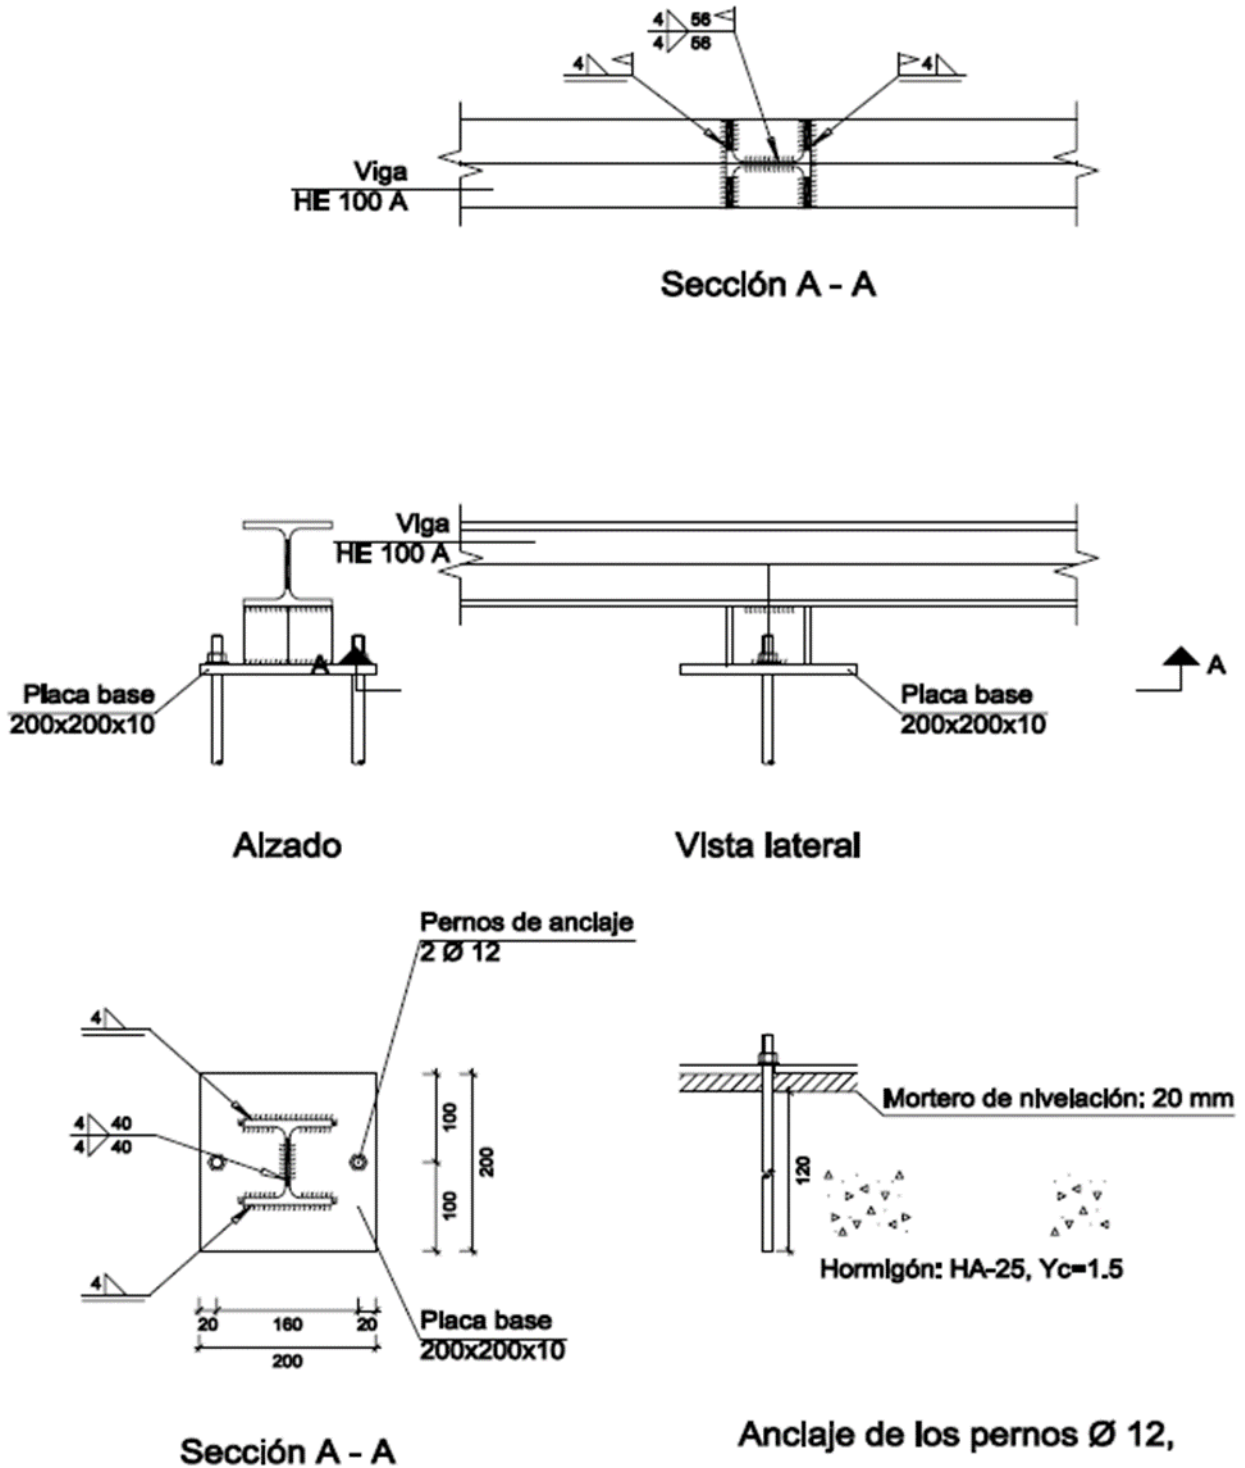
Detalle de la placa de apoyo anclada a la losa con 2 anclajes mecánicos.
